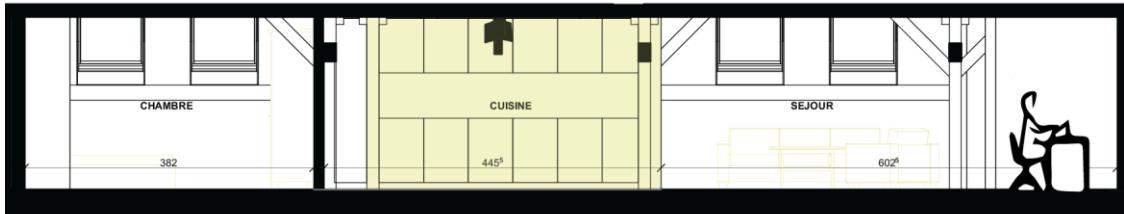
Coupe B1-B1 – Appartements 1, 2, 3
